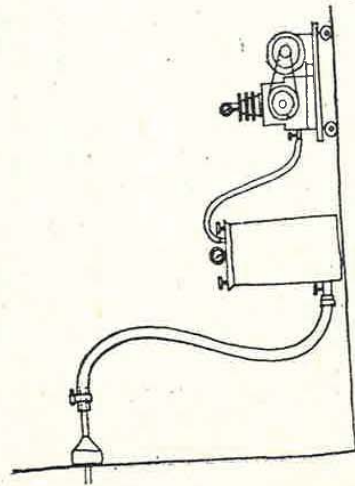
Injectare sub presiune obținută mecanic, cu ajutorul unui compresor.
